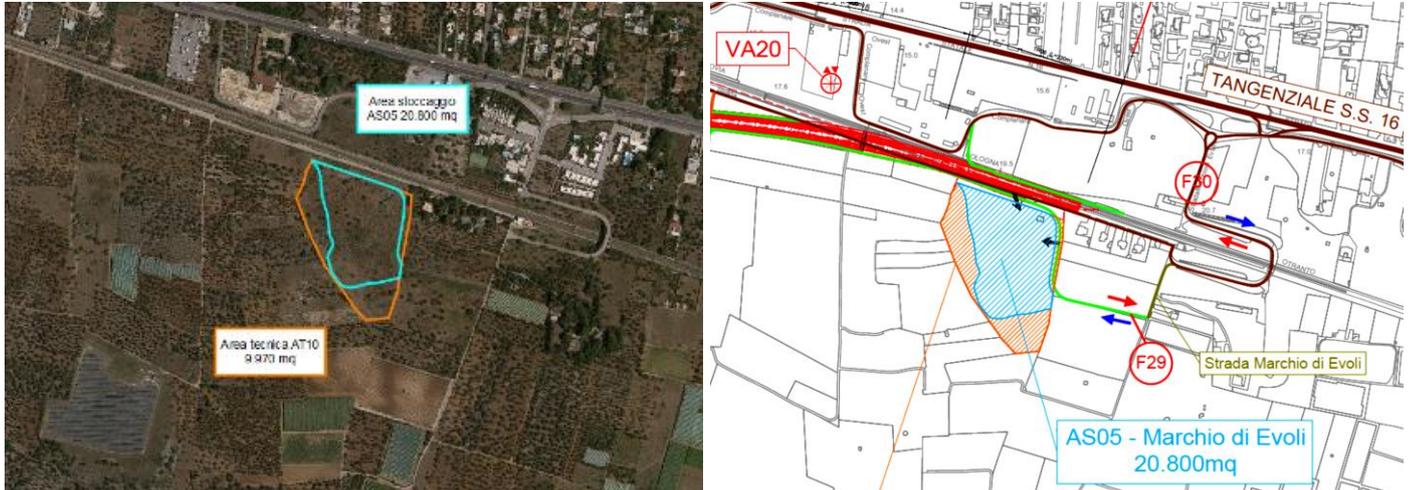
Vista aerea AT10 e AS05 e stralcio di cantierizzazione
